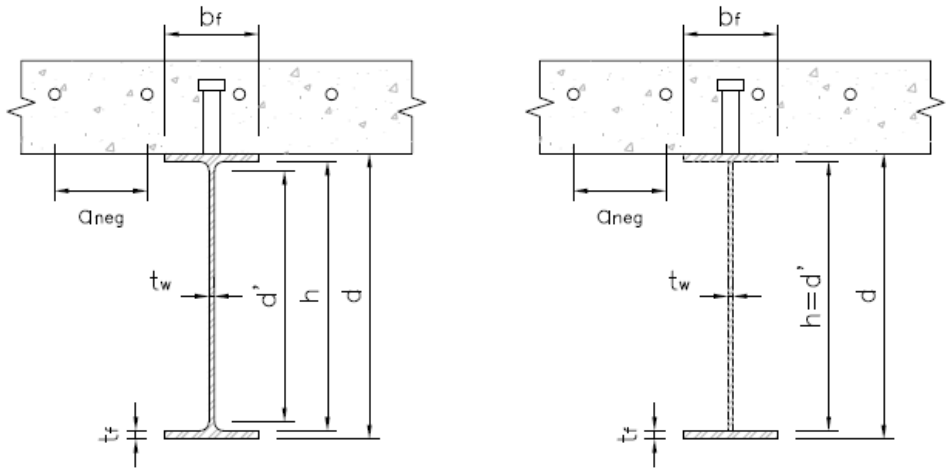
Seção transversal da viga mista, com perfil laminado e perfil soldado.
